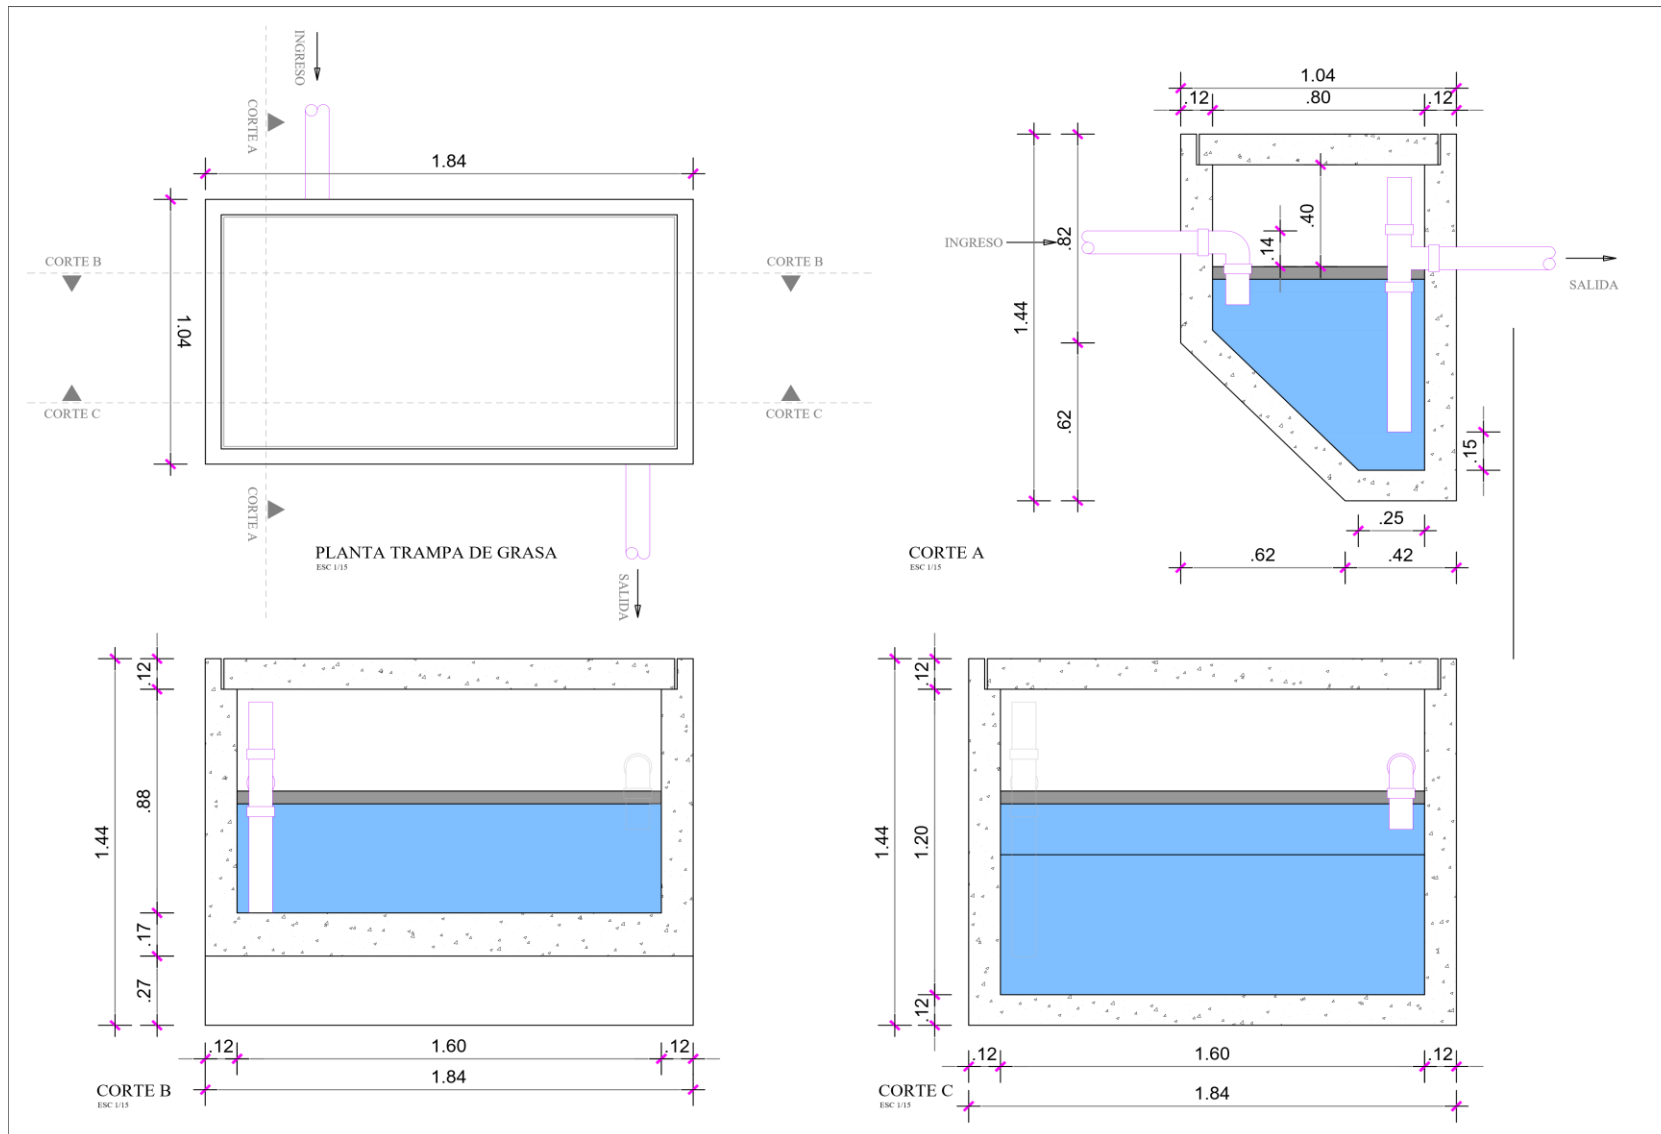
Cortes frontales, laterales y Visión 2D de las dimensiones de la trampa de grasa.
